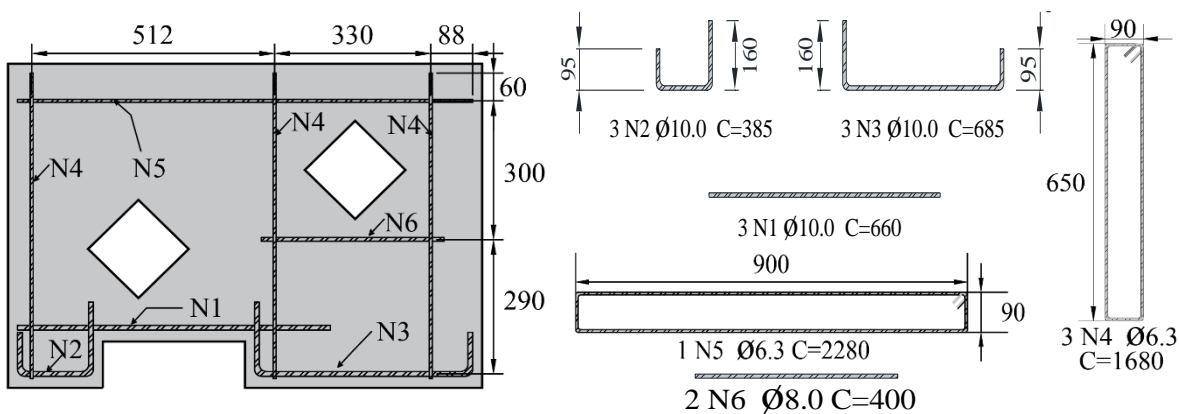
Detalhamento das armaduras DB1-W-H2-U, DB3-W-H2-U e DB3-W-H2-S-F (dimensões mm)
